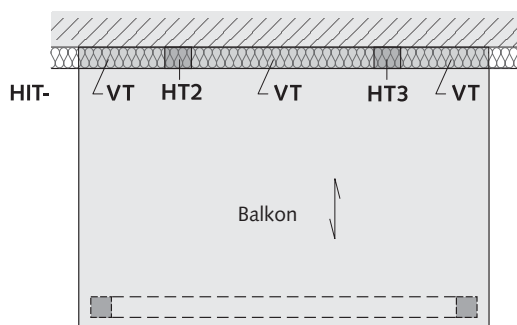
Gelenkig gelagerter Balkon auf Stützen. Zur Aufnahme von planmäßigen Horizontallasten werden HIT-HT Elemente eingesetzt.
